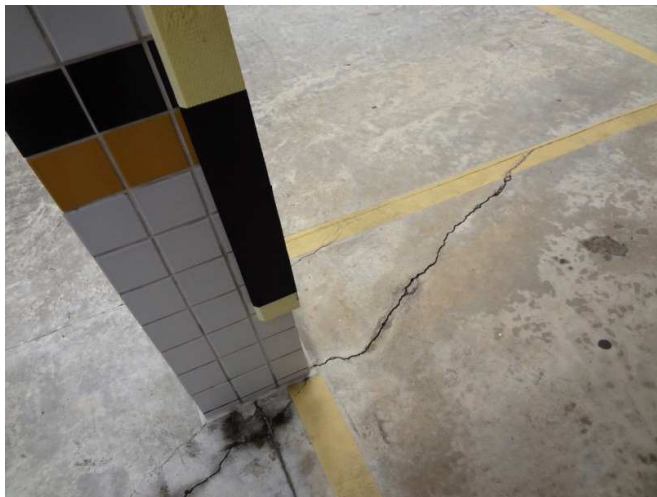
Fissura no piso do pavimento garagem semi-enterrado
